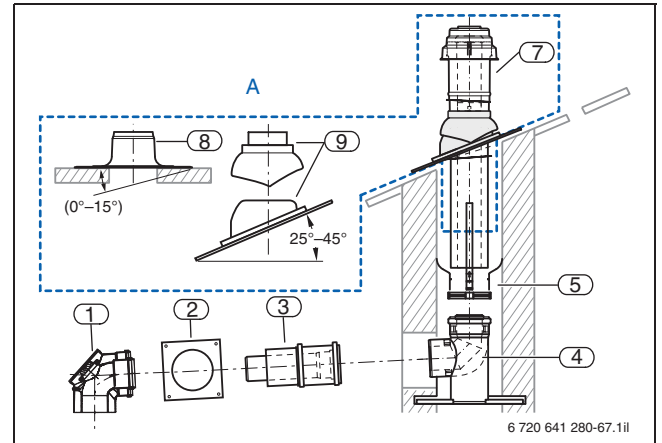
Konstrukční díly stavební sady DO-S z plastu
